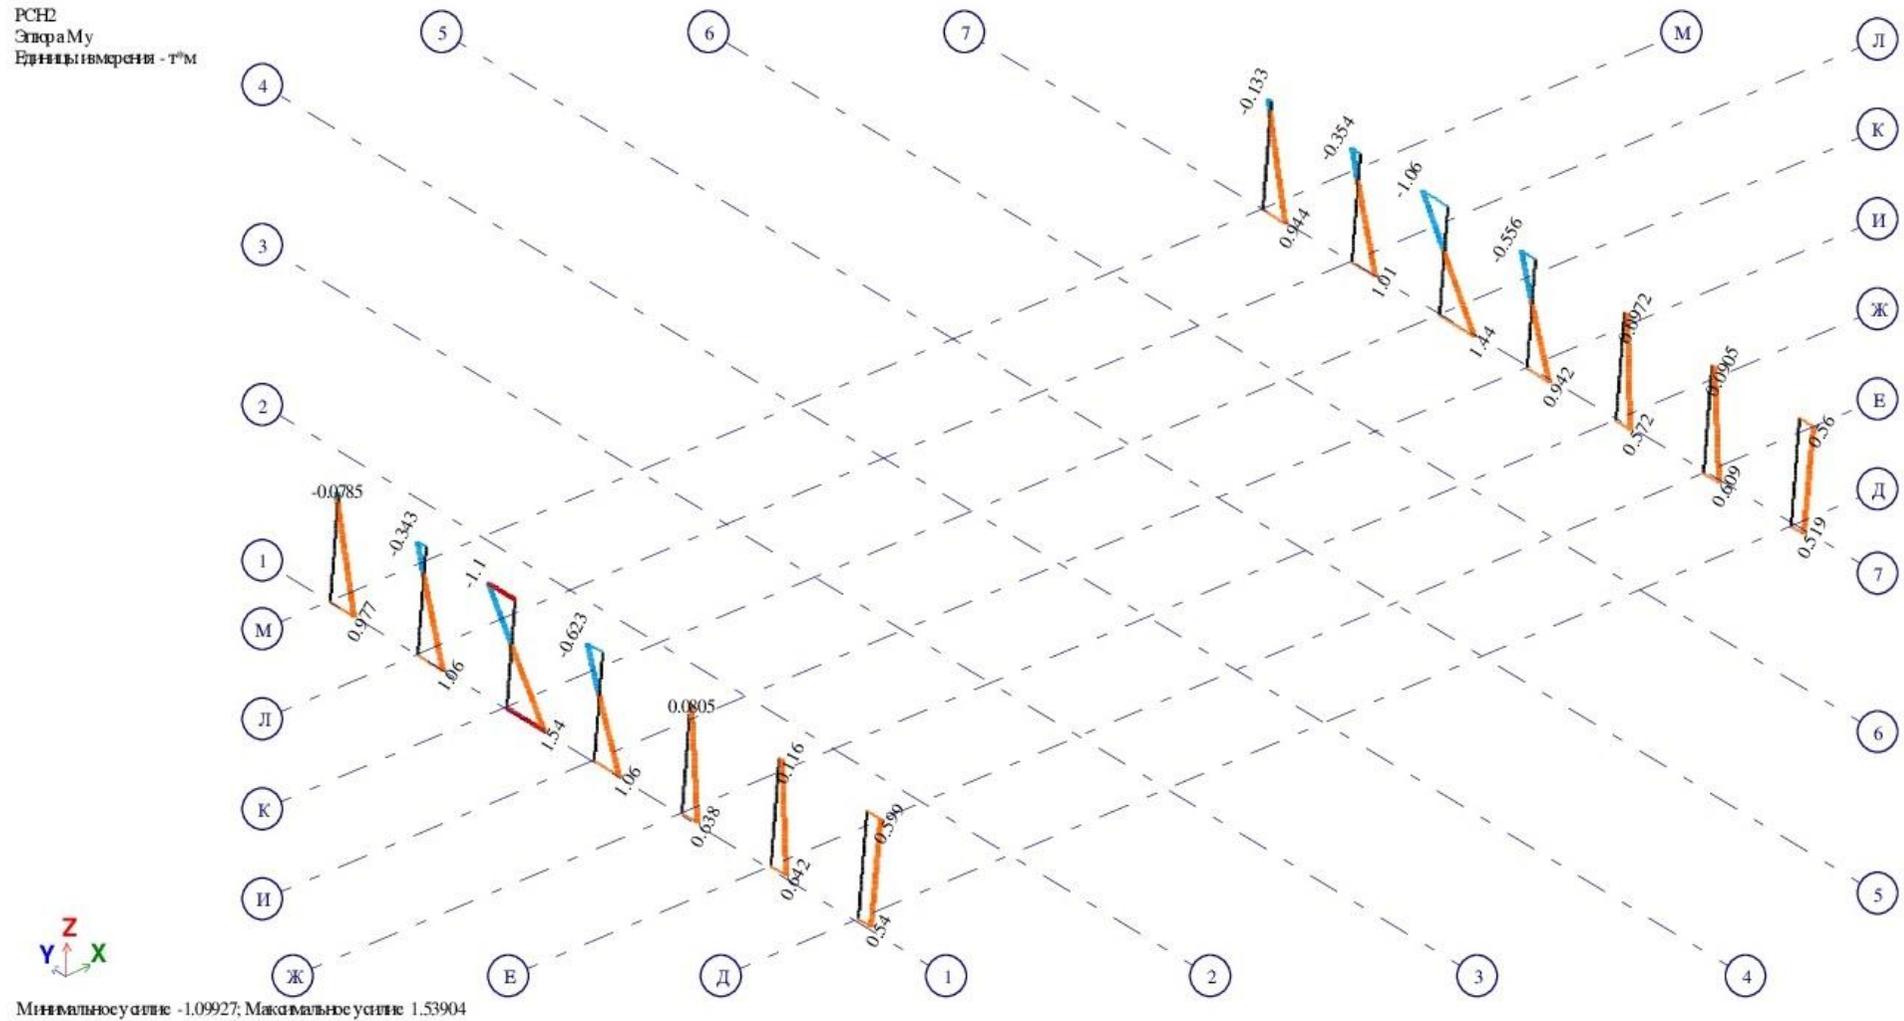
Схема нагрузок Му на фундаменты манеж
